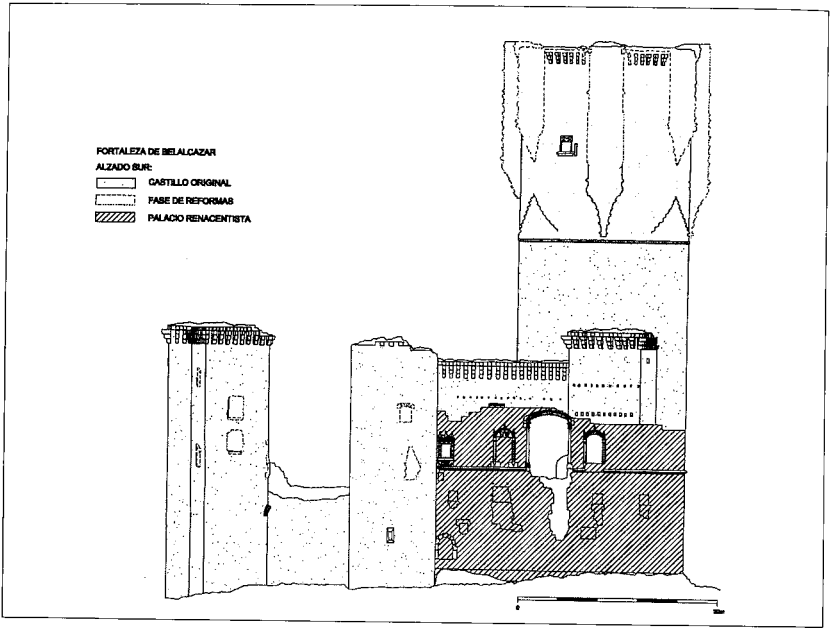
Fortaleza de Belalcázar. Alzado sur.
